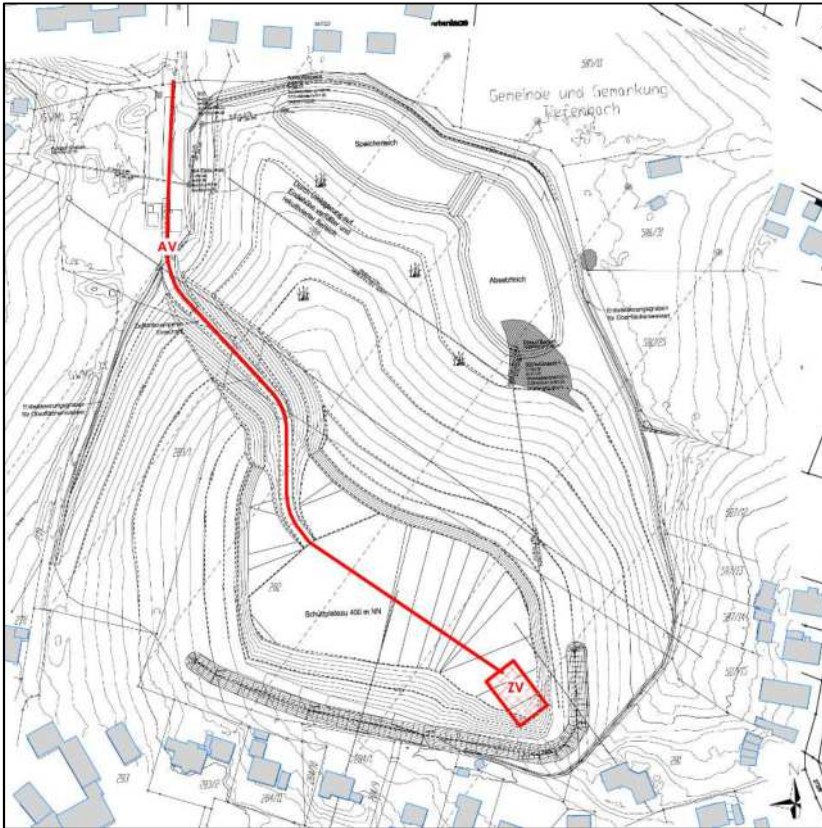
Lageplan mit Darstellung der relevanten Schallquellen – Variante 3
